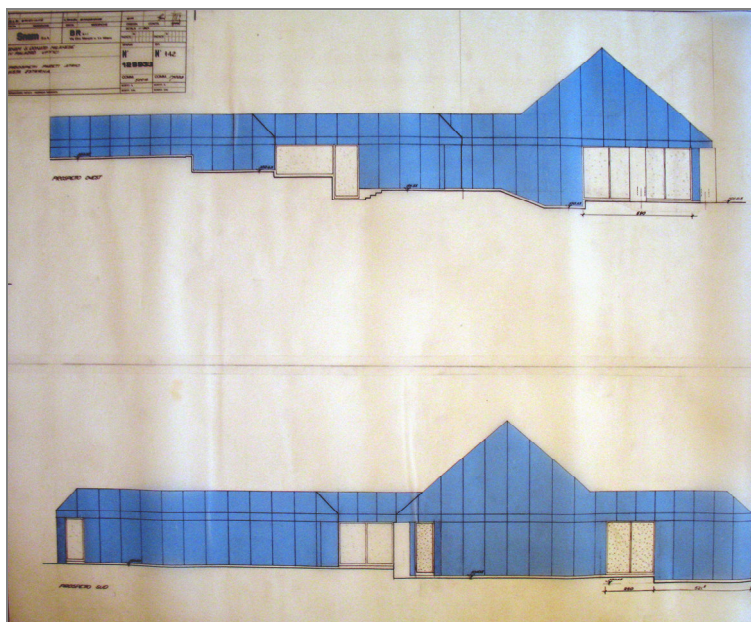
prospetti atrio (fonte CSAC – stralcio tav. 142, archivio n. 384-4)
